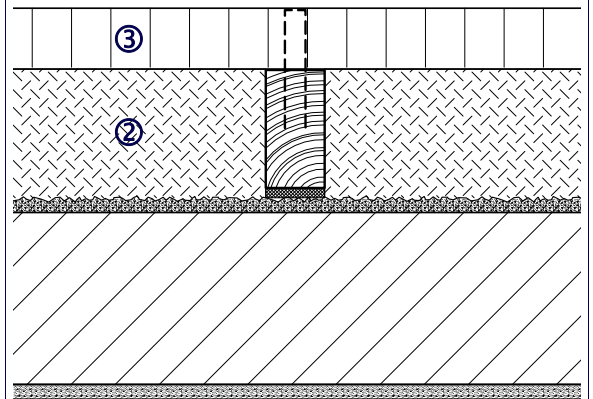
Erläuterungen zum Konstruktionsaufbau (Horizontalschnitte)
